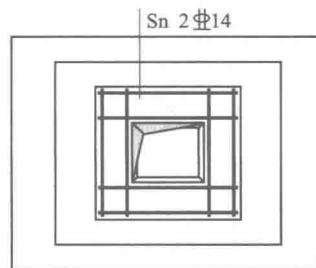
单杯口独立基础顶部焊接钢筋网示意
